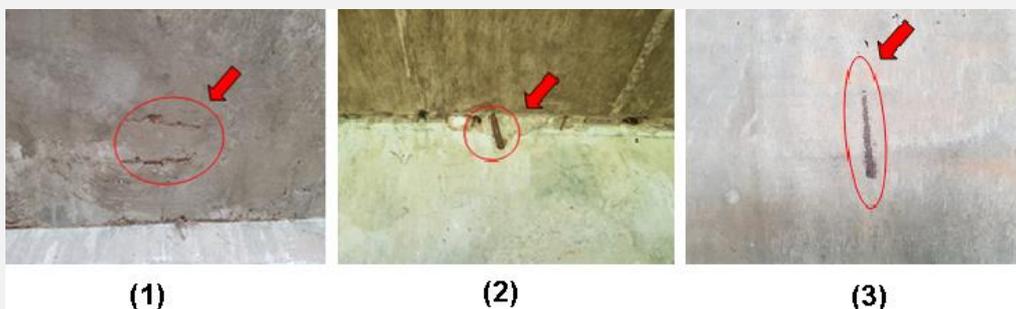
Armaduras expostas em diferentes elementos construtivos. (1) Armadura exposta na laje. (2) Armadura exposta na viga. (3) Armadura exposta na parede. Fonte: Autores.
